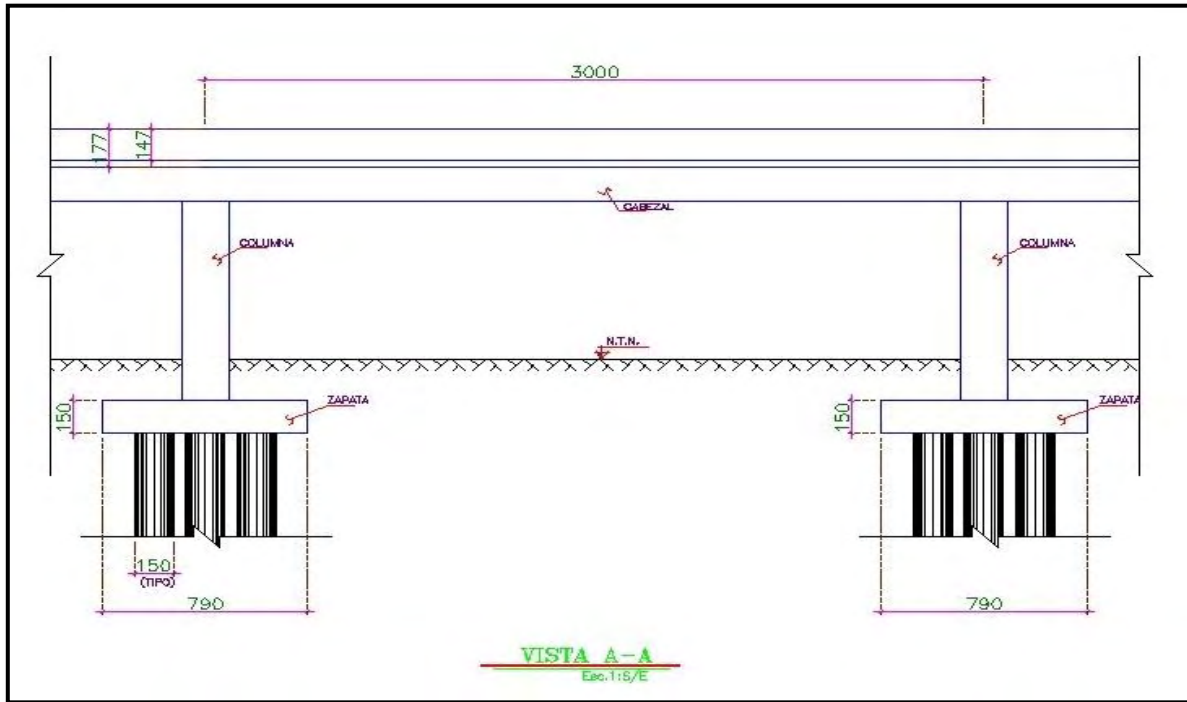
como se muestra en las figuras 12 y 13, esta es la distribución que tendrán las columnas a lo largo del viaducto, es decir una separación de 30.00m entre el centro de cada columna, esto es debido a que las piezas serán prefabricadas y se tiene una medida estándar en las plantas de armado.
